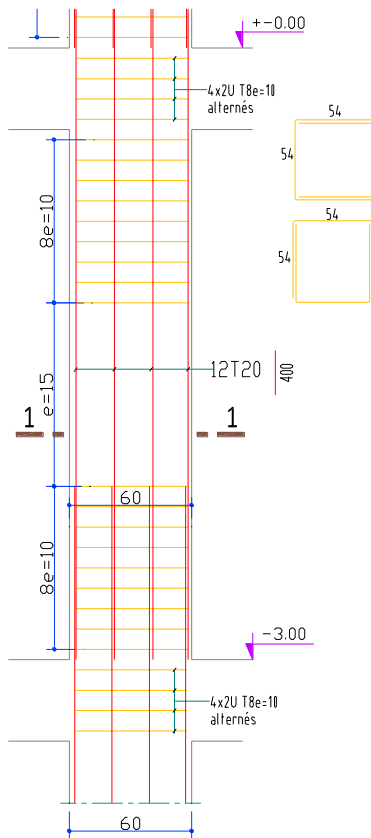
Coupe verticale de ferrailage des poteaux 60 × 60 cm².
